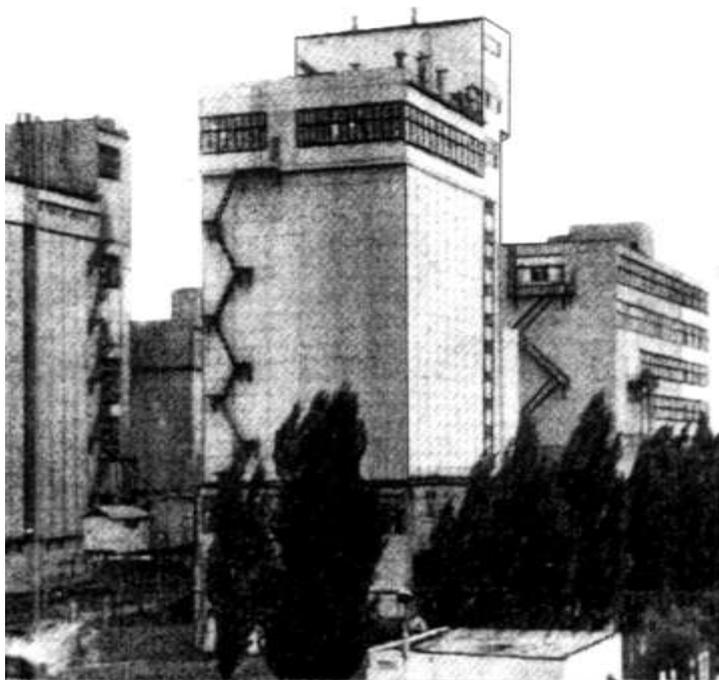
Стальные лестницы на фасадах промышленных зданий
